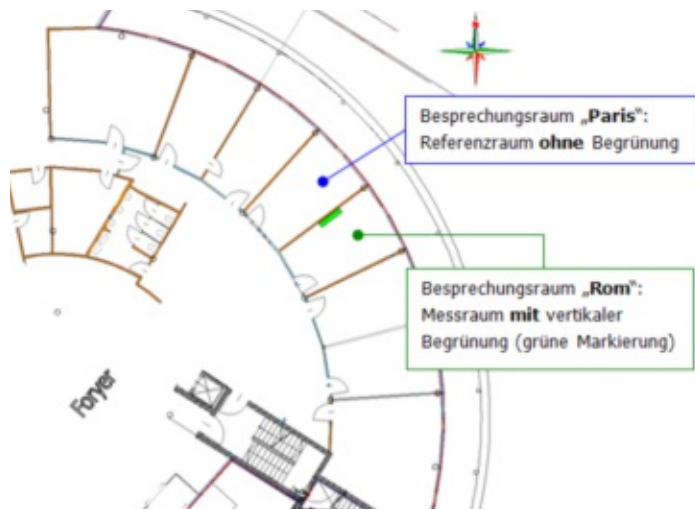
Ausschnitt vom Grundrissplan, Florawall
